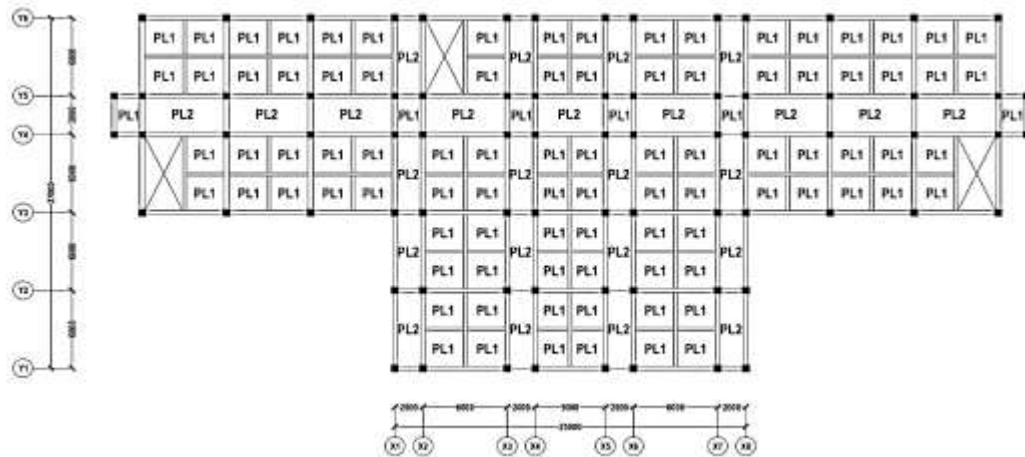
Denah Balok Lantai 2 Gedung Balai Latihan Kerja (BLK)
